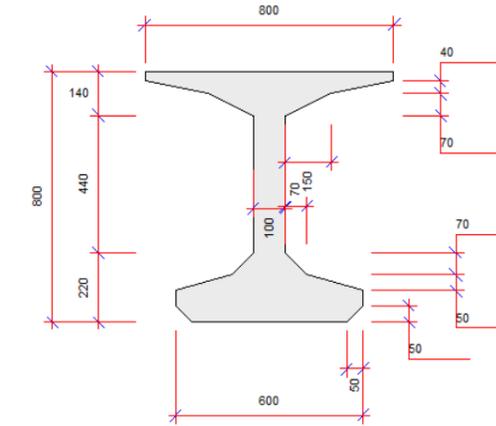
Viga prefabricada DT-ALV-80-80. Cotas en cm
